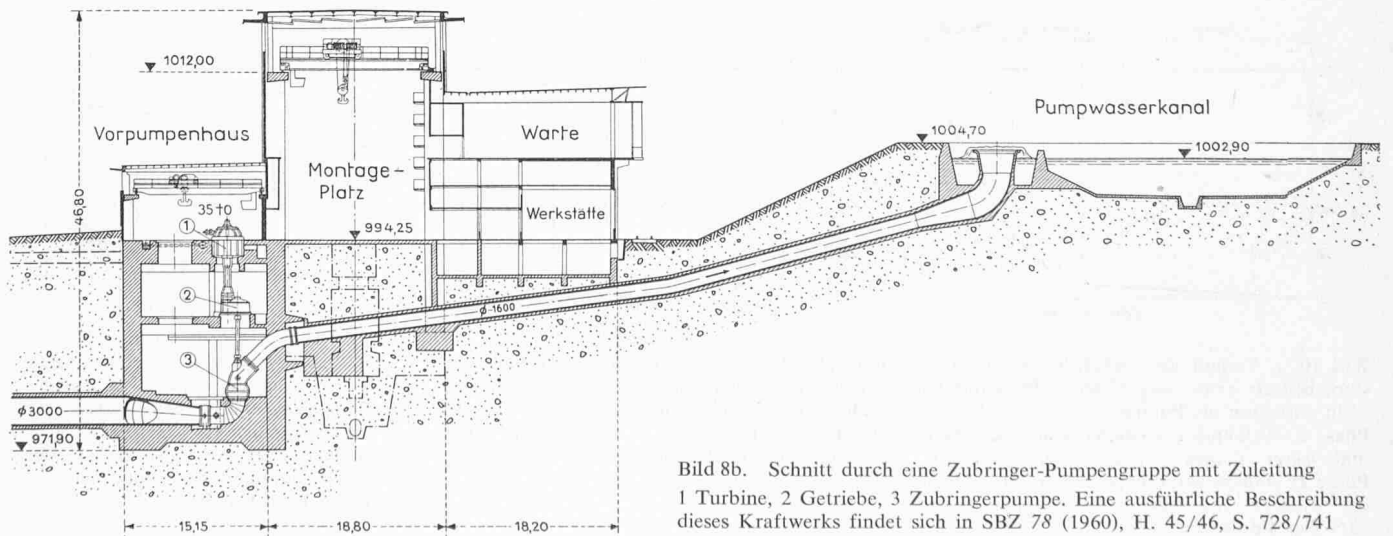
Schnitt durch eine Zubringer-Pumpengruppe mit Zuleitung
